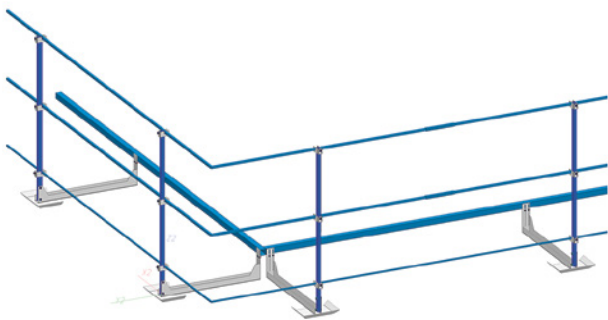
Geländer ohne Dachhautdurchdringung; wird an der Unterkonstruktion der Photovoltaikanlage stabilisiert
